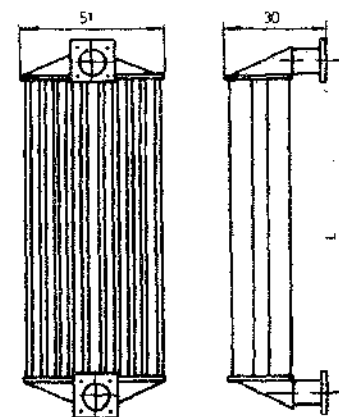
Radiatoare cu țevi drepte. Dimensiunile sînt în cm.
